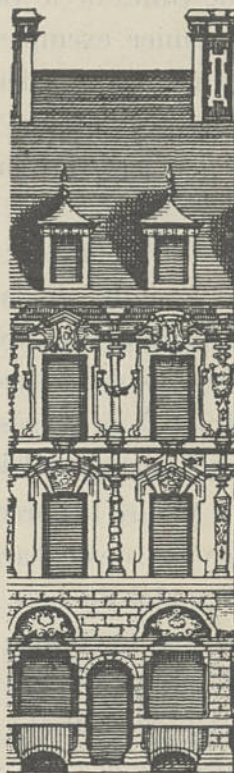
Bourse de Lille, maison d'une façade (1652).
